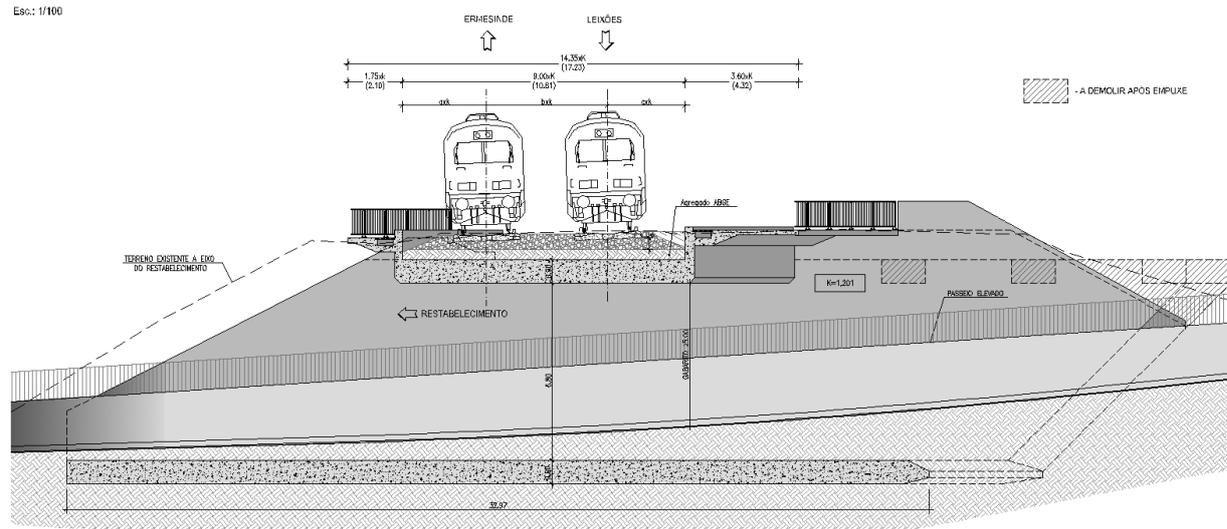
Corte Longitudinal da PIR São Gemil
